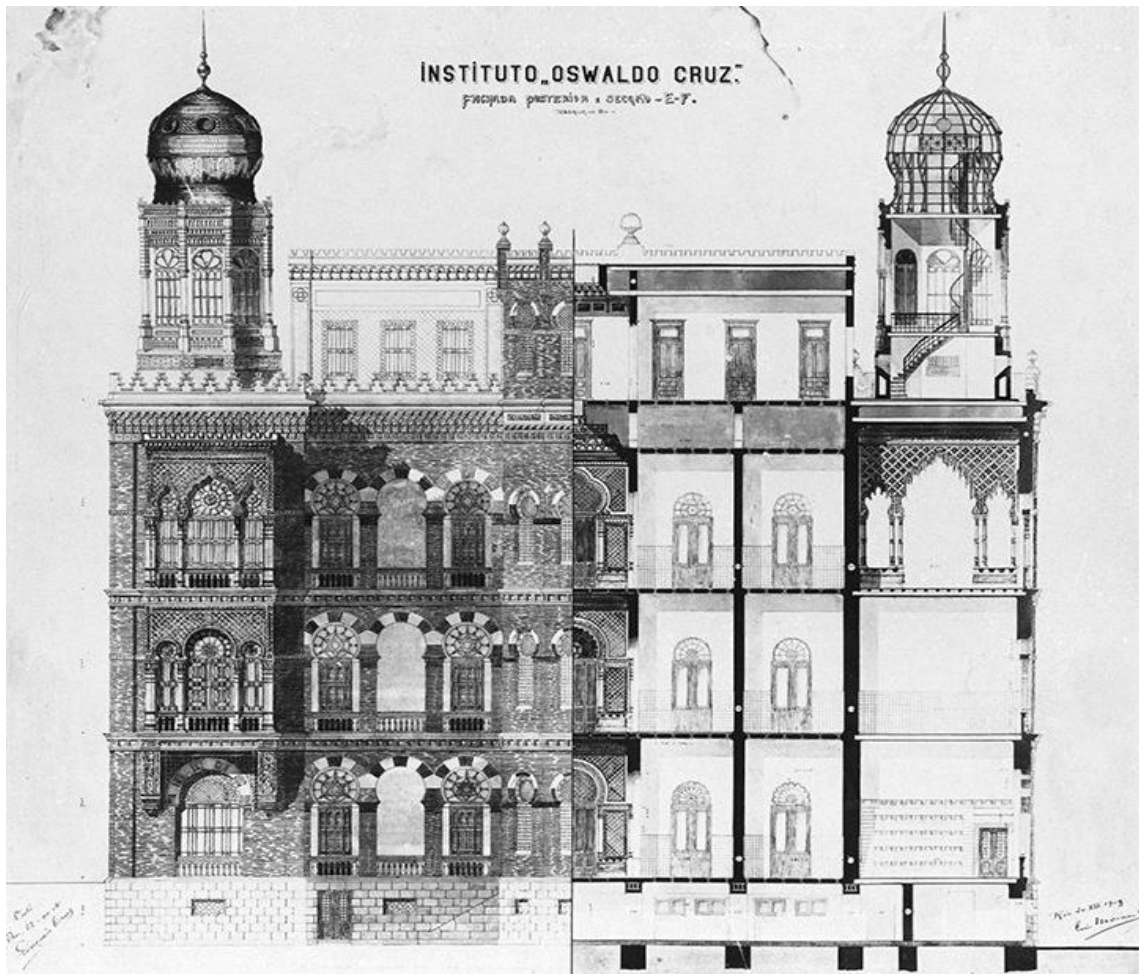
Fachada e Corte Pavilhão Mourisco (Fonte: COC/Fiocruz)
